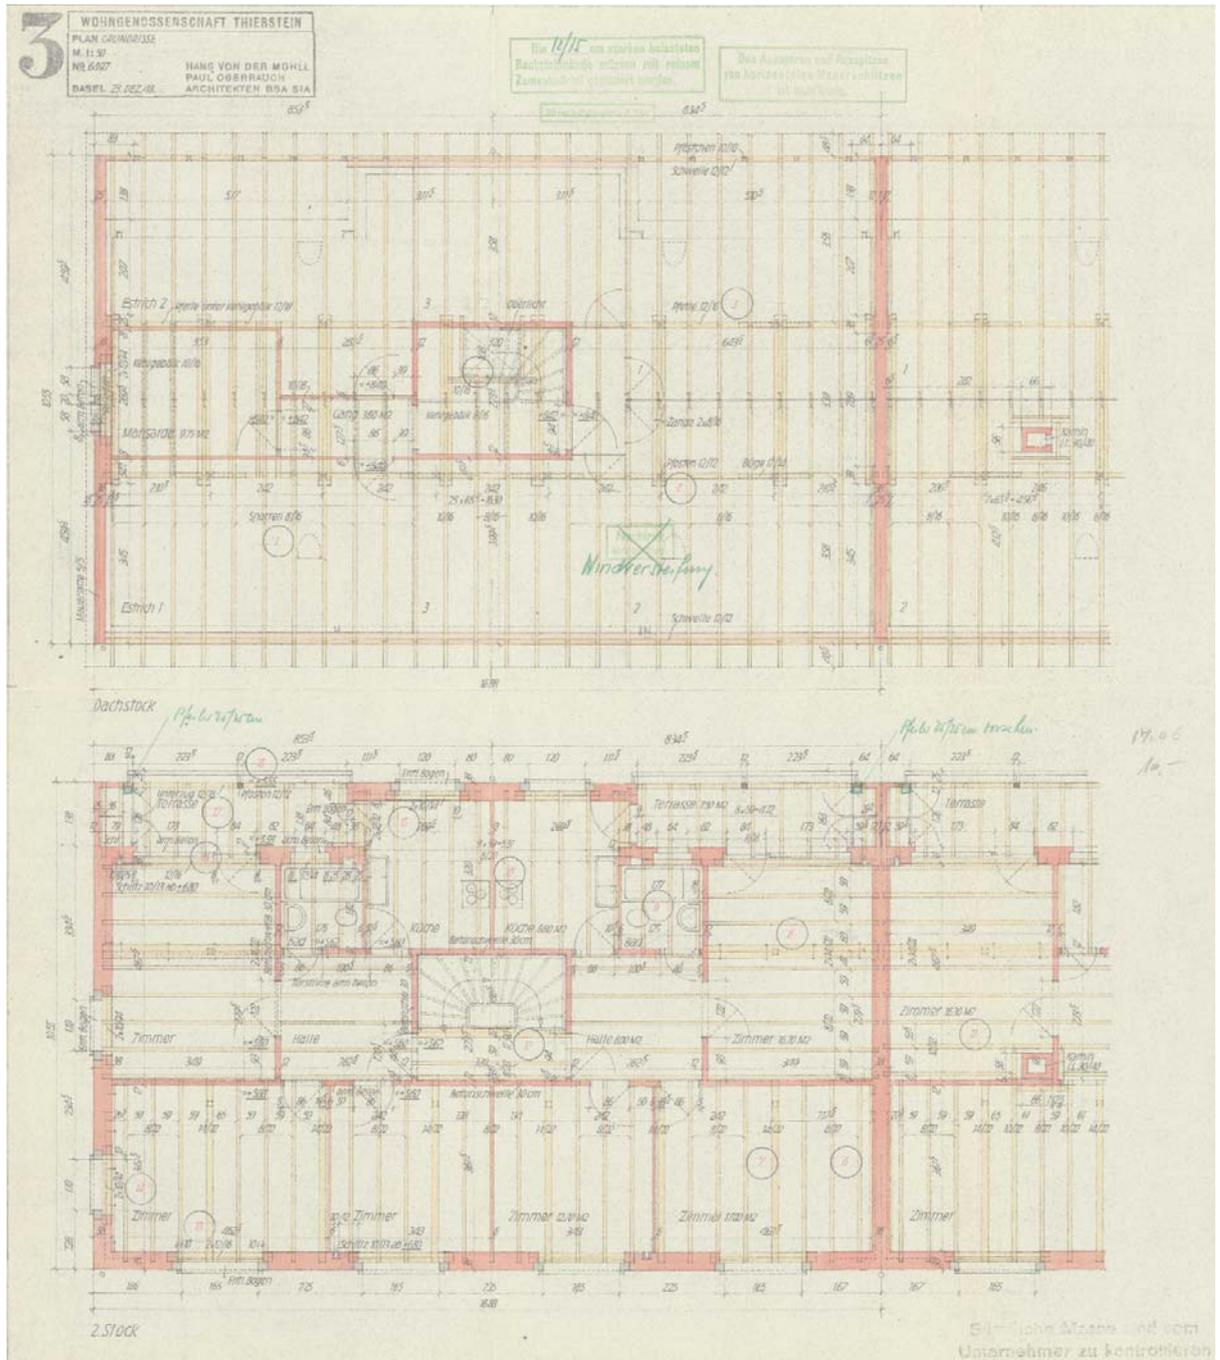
Dachstock (oben) und 2. Obergeschoss (unten), Plan 1:50, 1. Etappe, 1943 [Quelle: StaB]
